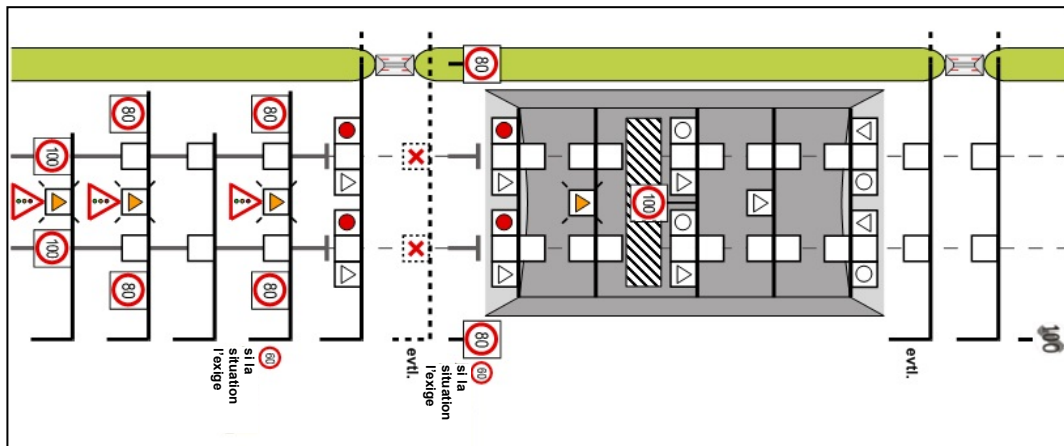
Plan de feux – Fermeture du tunnel.
